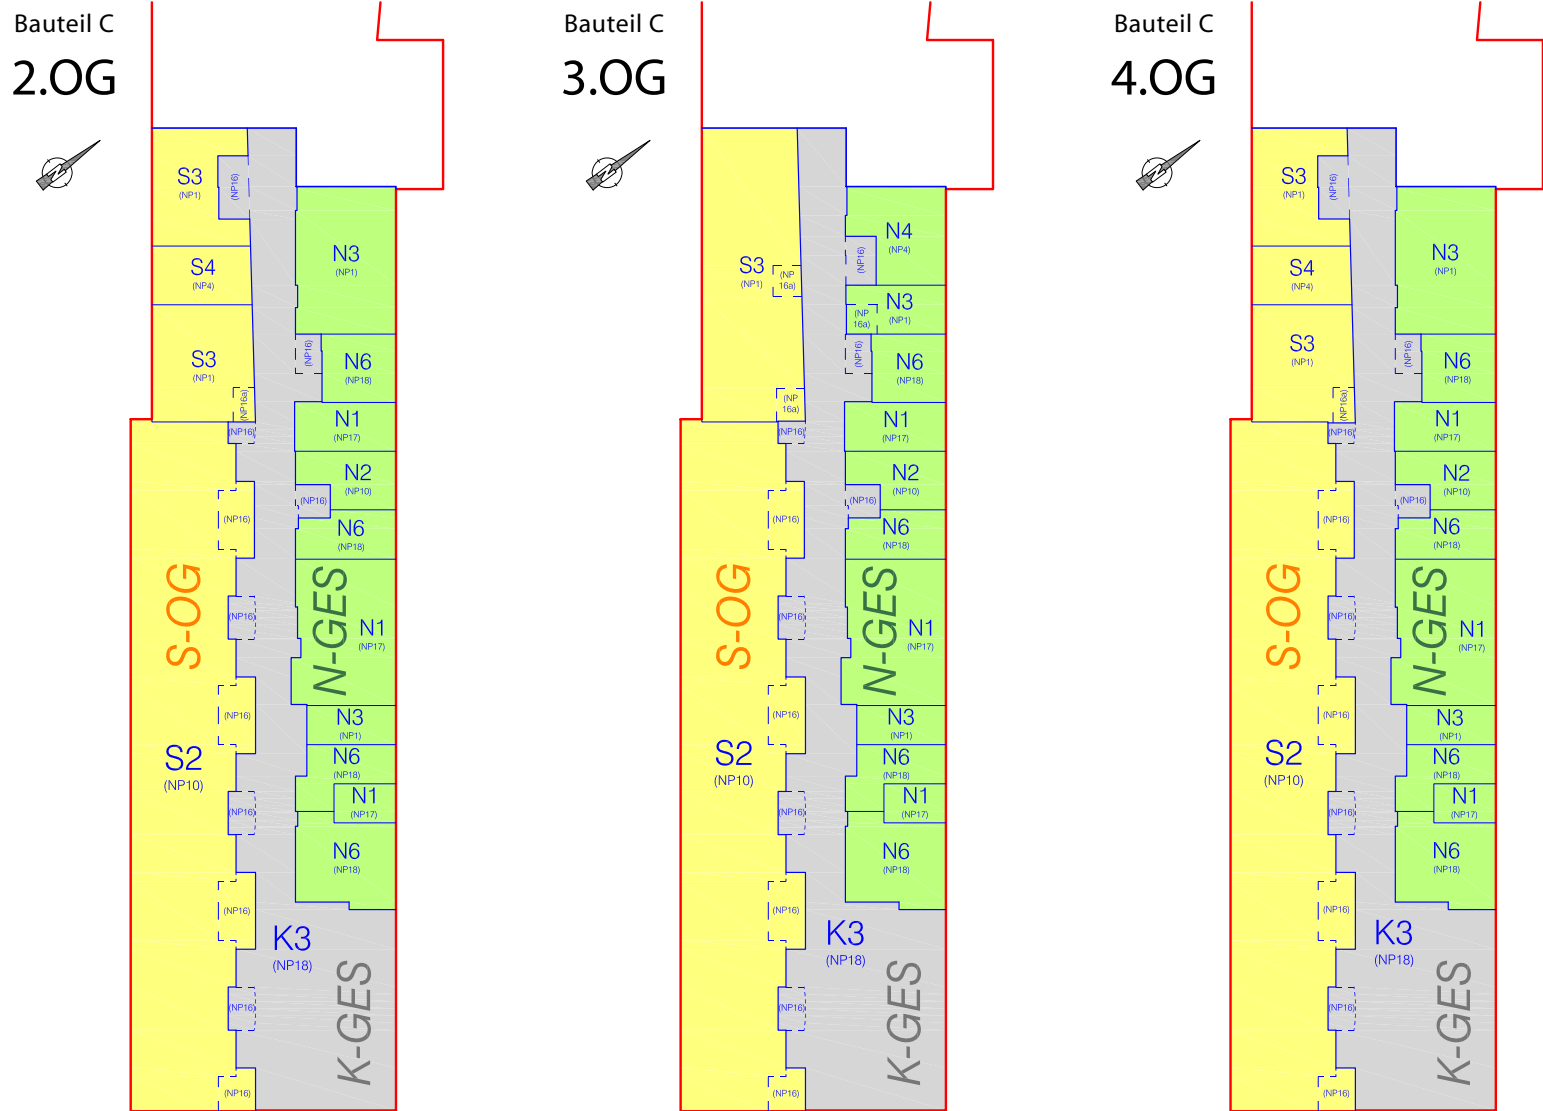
Zonierung Bauteil C – Teil 2 (2. Obergeschoß - 4. Obergeschoß)
